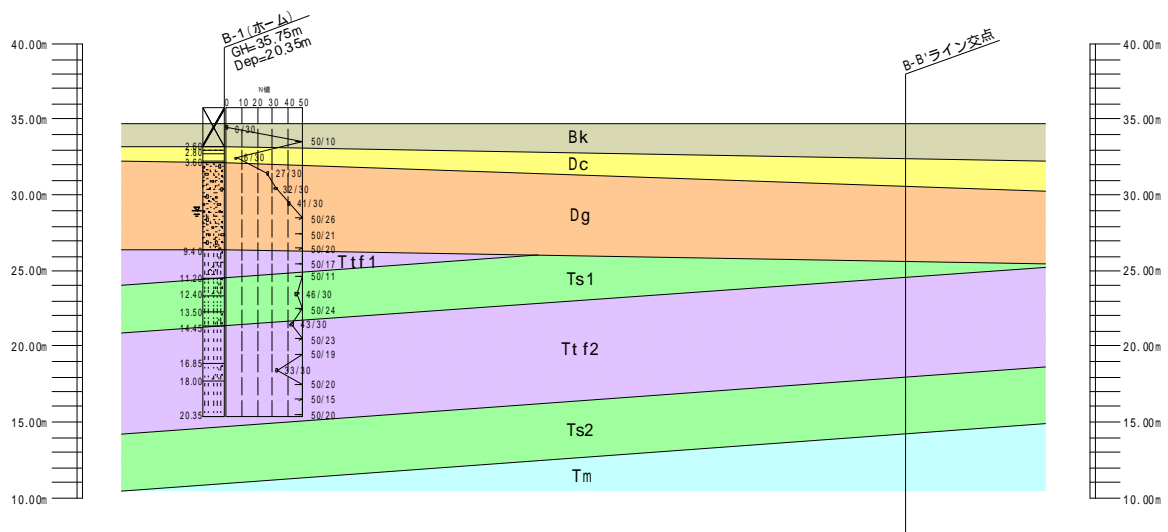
土層断面図 (A - A'断面) S=1:500
